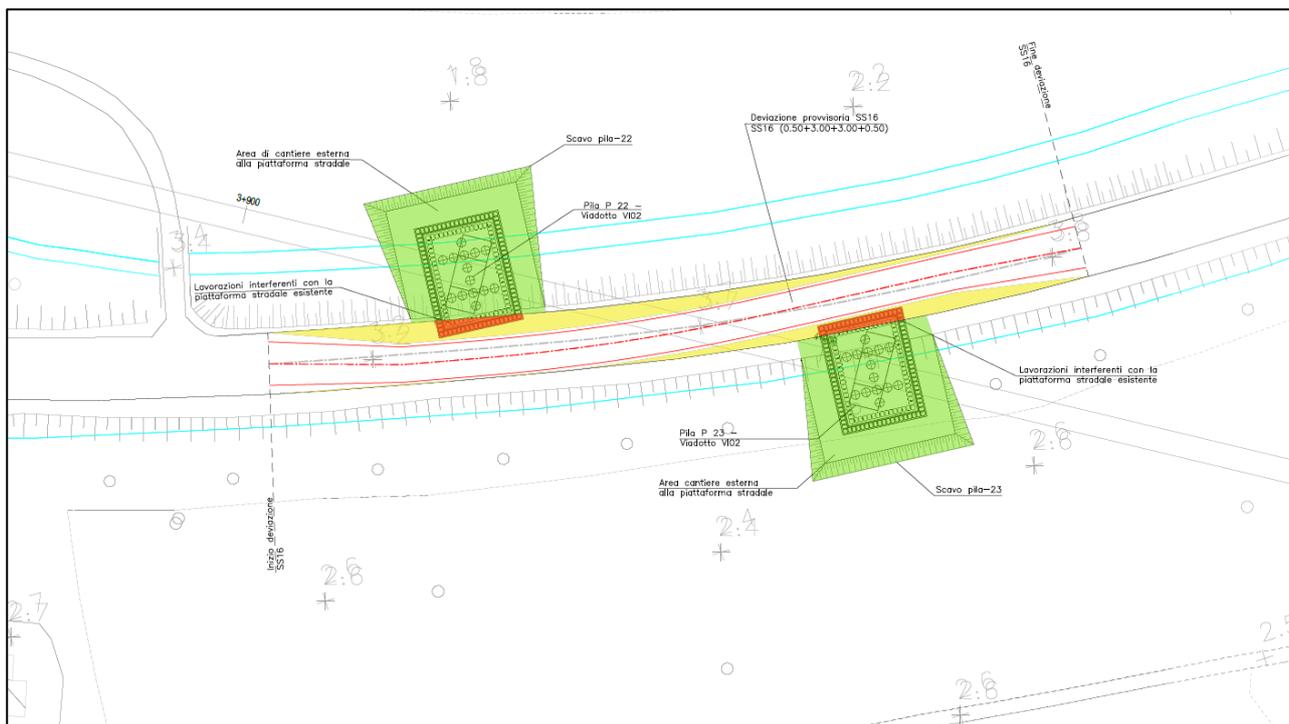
Planimetria deviazione provvisoria in sede fasi realizzazione VI02
